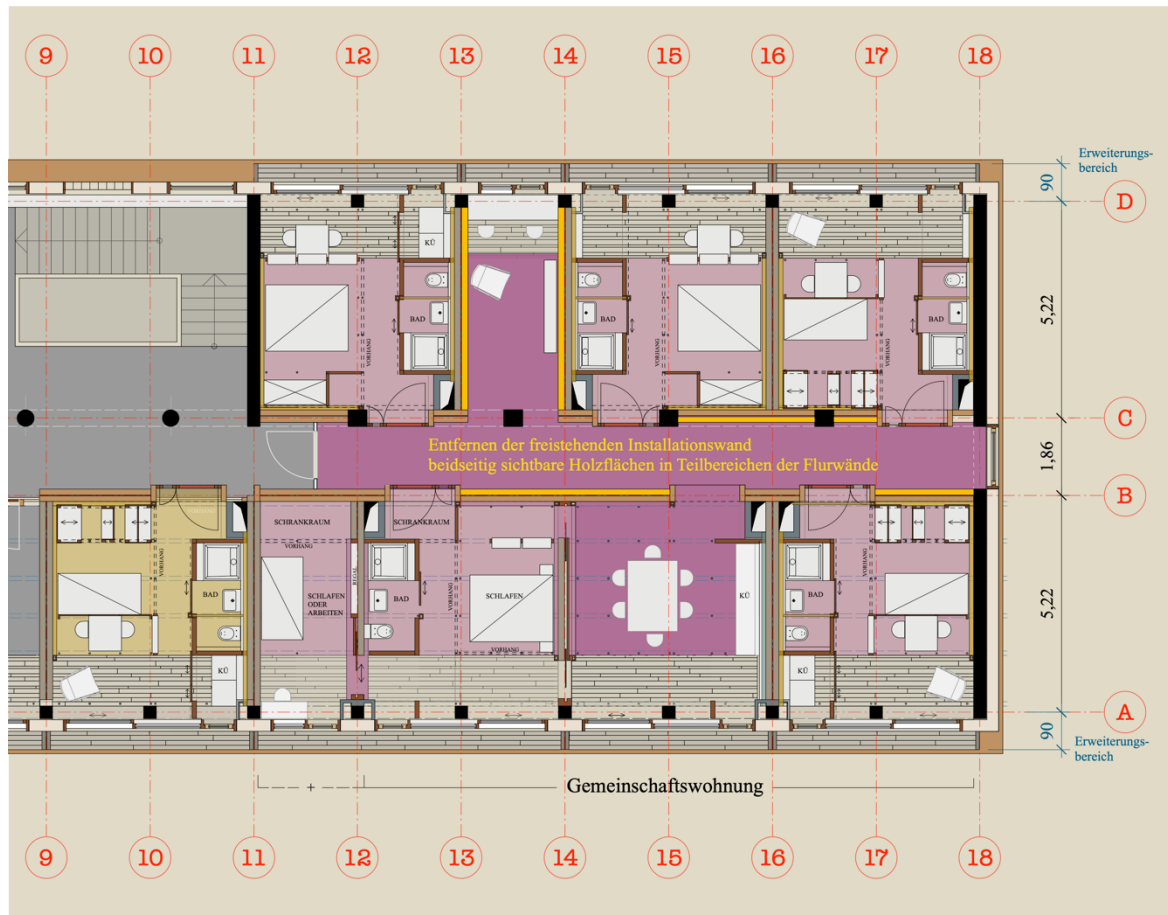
Darstellung Grundriss einer großen Wohneinheit mit sichtbaren Holzflächen
